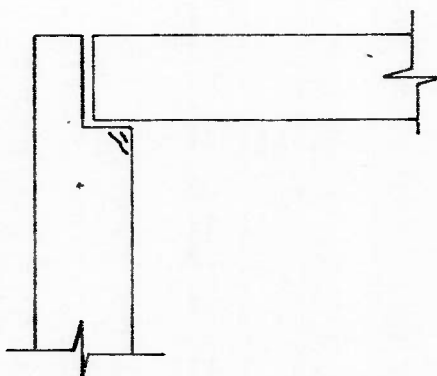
Fissuras inclinadas na cabeça do pilar provocadas por concentração de tensões
